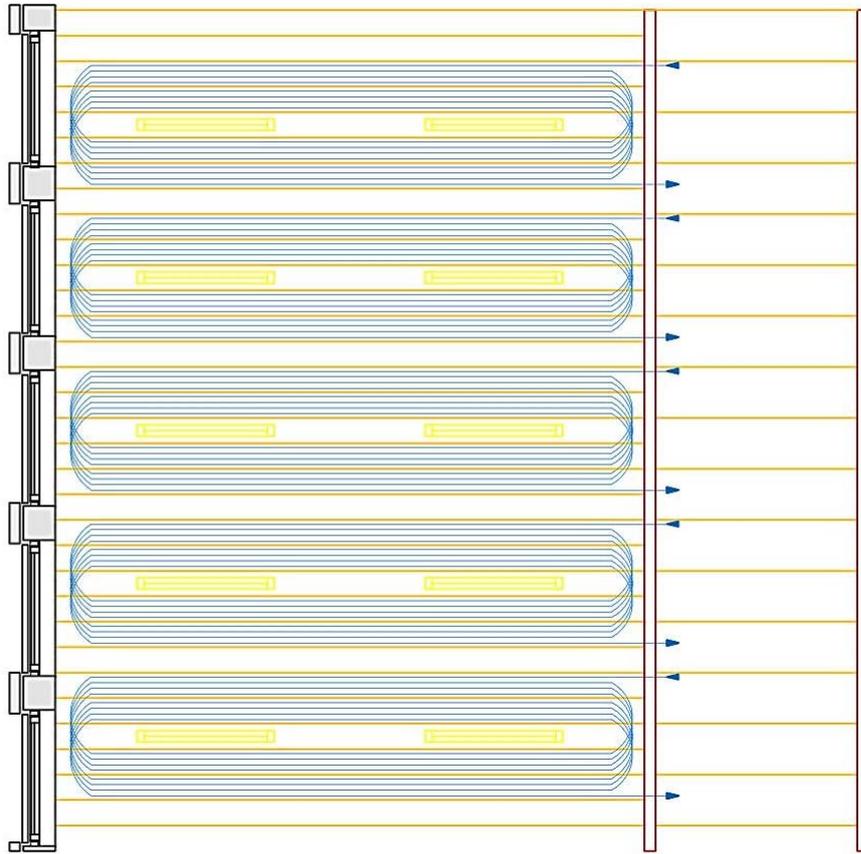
exemple de plan de principe plafond Easy-Klima Plus®, exemple lames 225 mm largeur, modulation 1350 mm
